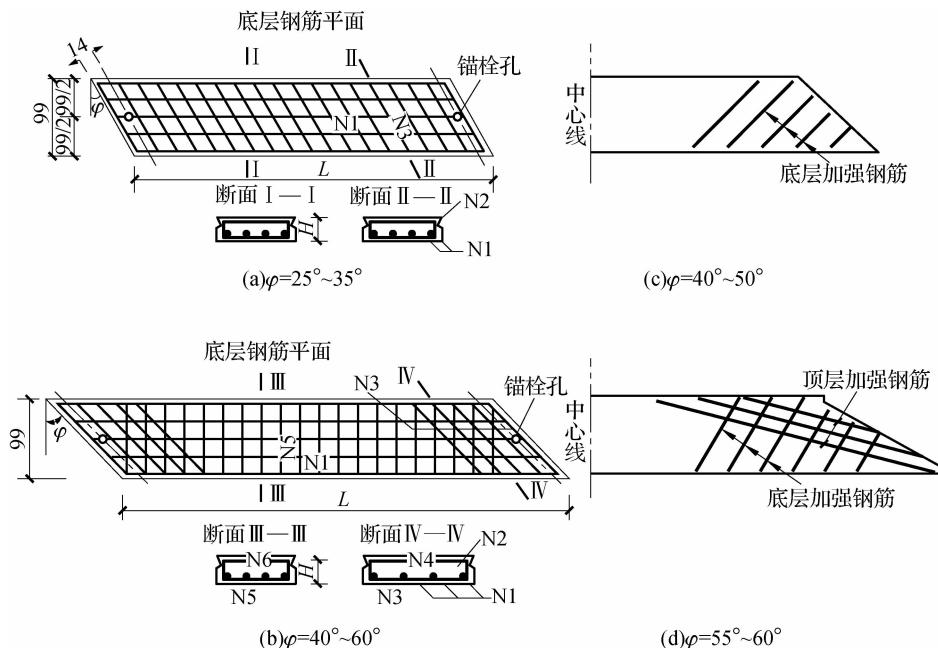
装配式斜板钢筋构造示例(尺寸单位:cm)
